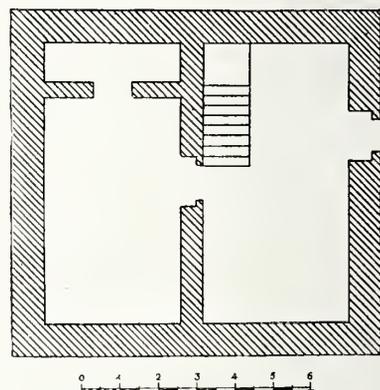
PIANTA DELLA TORRE DI *VÒILA.
